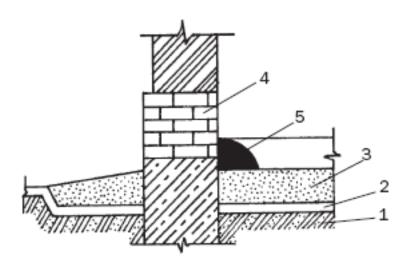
Устройство цоколя: 1 – грунт; 2 – песок; 3 – бетон; 4 – стена; 5 – стык
